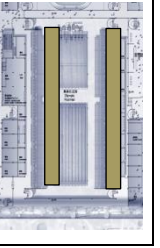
Londra Olimpik Su Sporları Merkezi plan ve şematik ilişkisi (www.archdaily.com).
